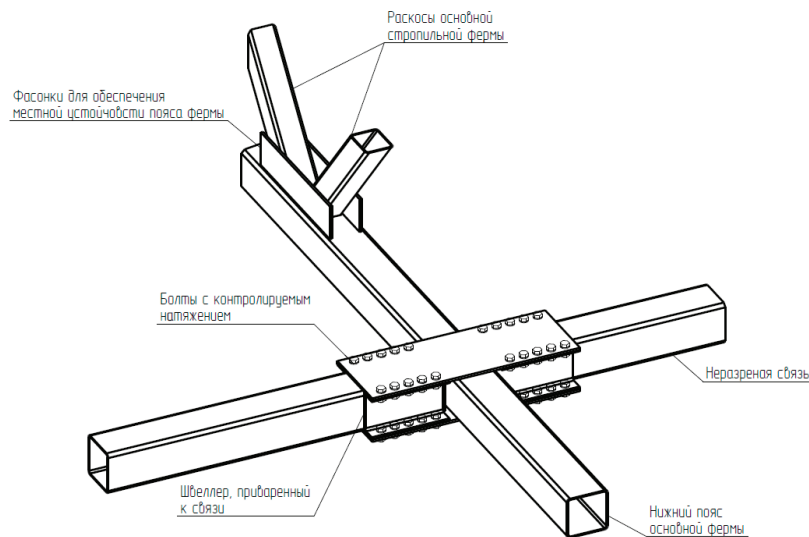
Конструкция узла крепления неразрезных связей к нижнему поясу фермы
